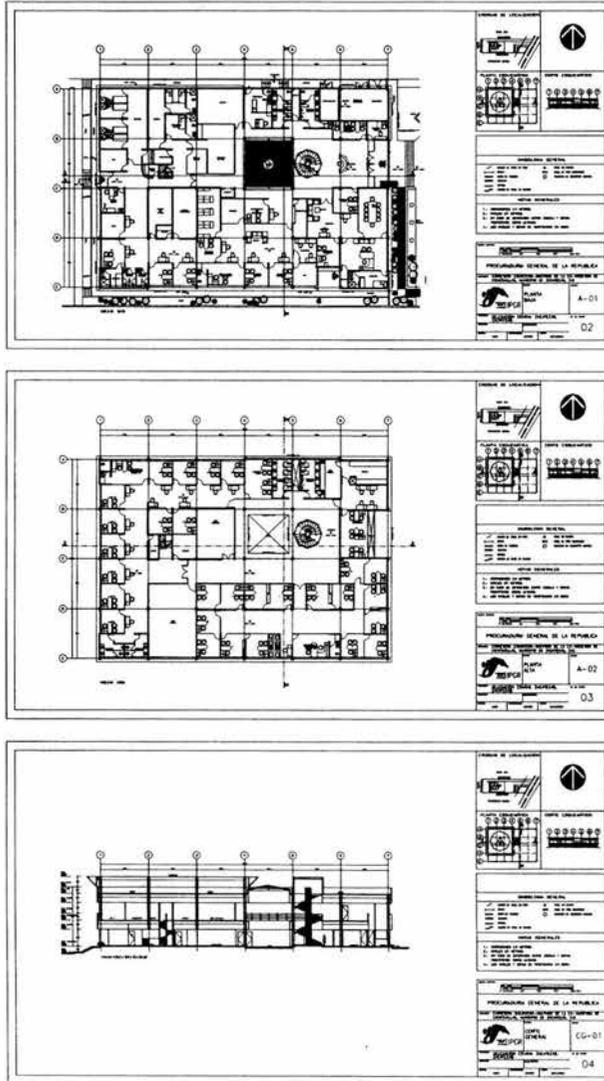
, c, d PROYECTO EJECUTIVO PLANTA BAJA, PLANTA ALTA Y CORTE RESPECTIVAMENTE
